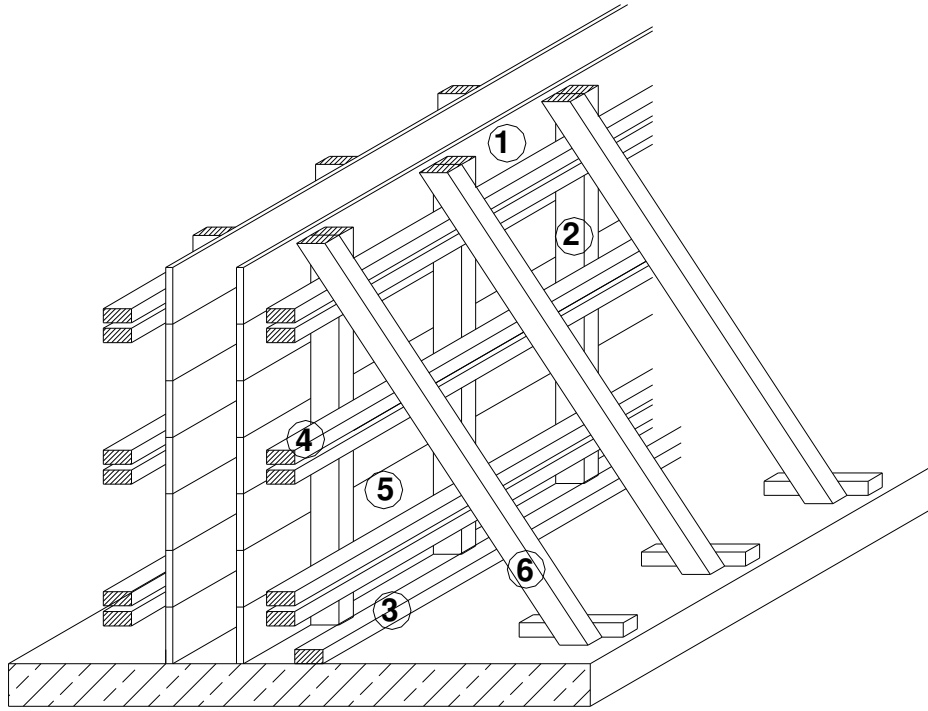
Döşeme, perde duvarı, kolon ve kiriş kalıp yüzeyleri (82)
